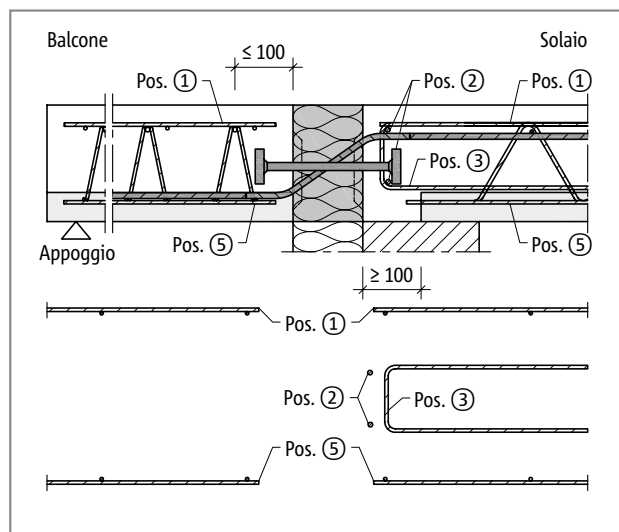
Schöck Isokorb® tipo QPXT: armatura in opera
